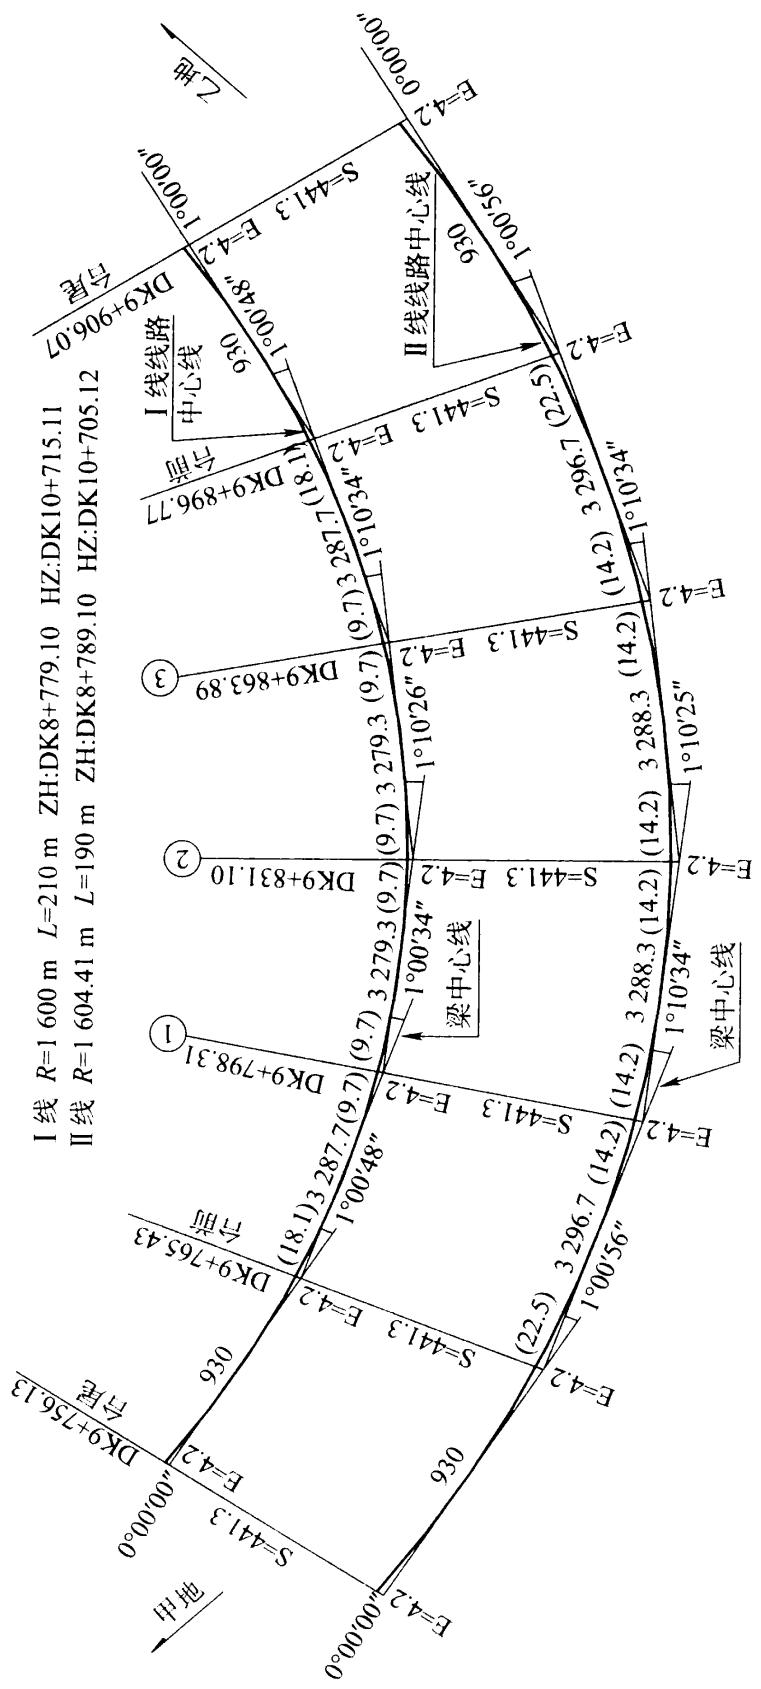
2 双线铁路桥梁曲线布置平面示意图的标注
